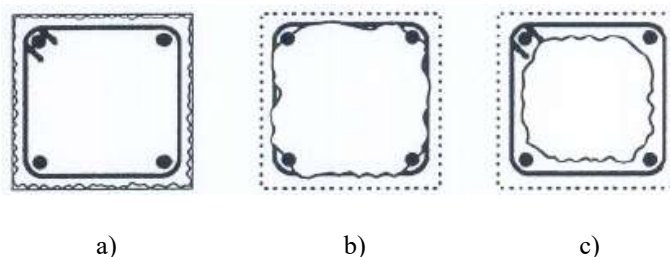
a) Preparação criando maior rugosidade; b) Preparação deixando expostas as armaduras; c) Preparação deixando as armaduras livres [32]
